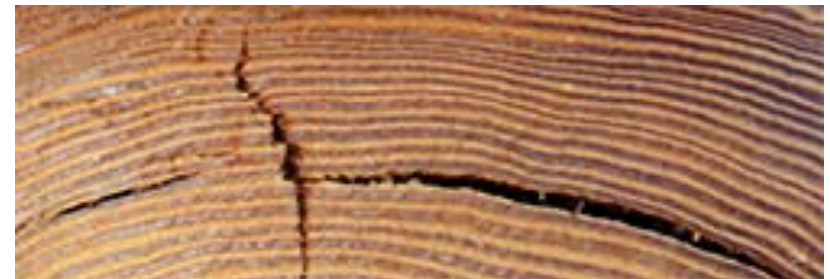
Detalle de separación de los anillos de crecimiento. (AEIM)
